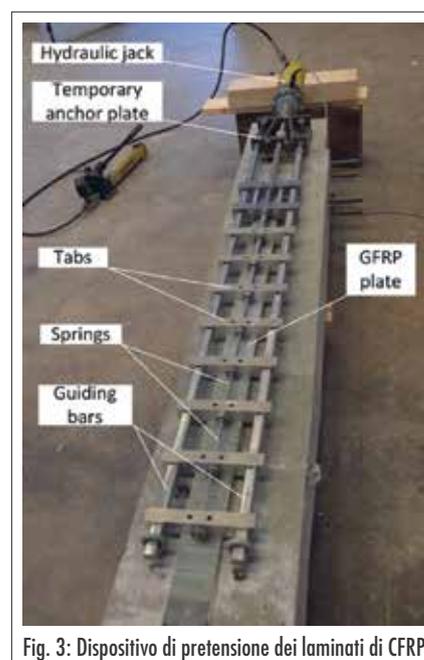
Dispositivo di pretensione dei laminati di CFRP
